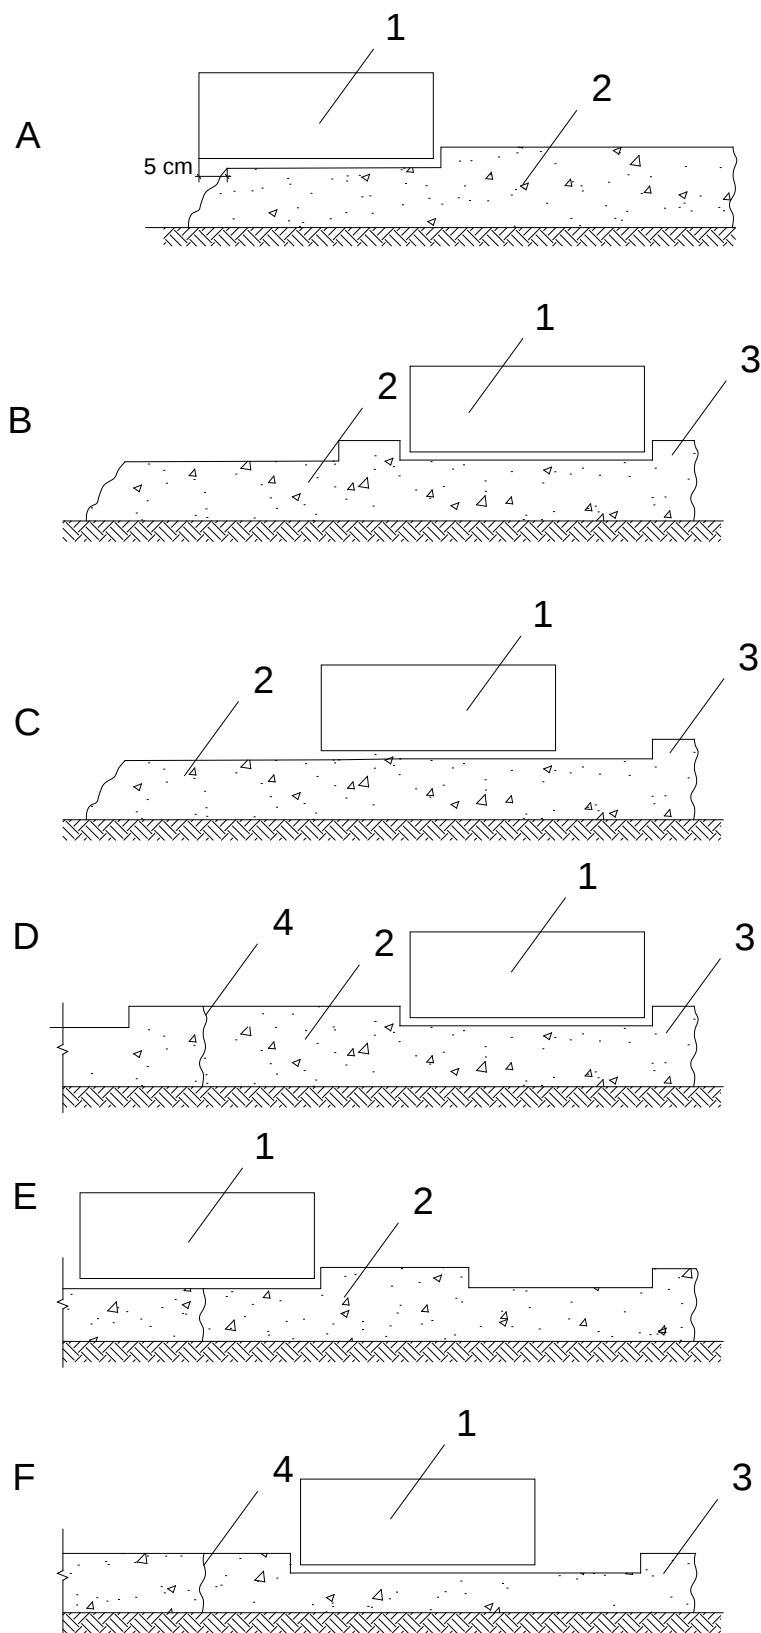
Схема уплотнения свежеложенных первой и примыкающих полос основания из укатываемого бетона (поперечный разрез)
